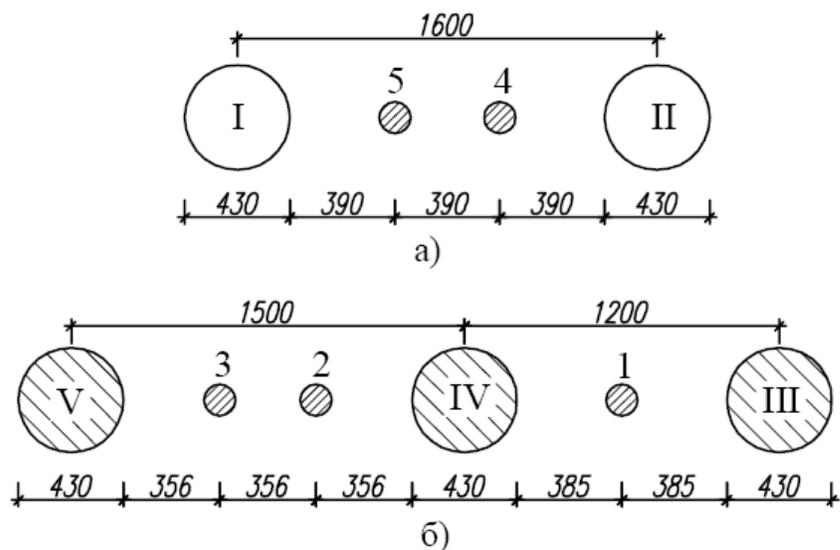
Фрагмент плана размещения “пробитых” (I, II) и изготовленных (III – V) грунтовых свай. Площадка строительства №2.
